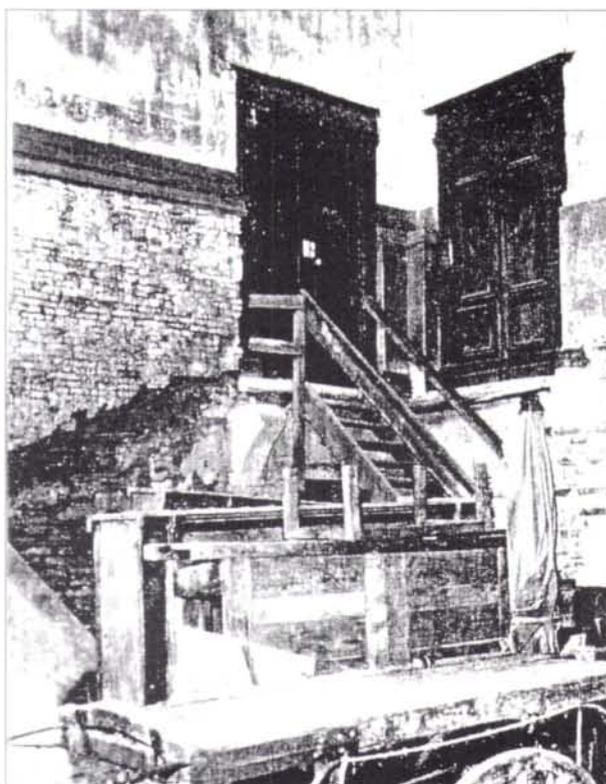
HÔTEL DE NUPCES. ÉTAT DE L'ESCALIER D'HONNEUR avant restauration : saignée apparente.
